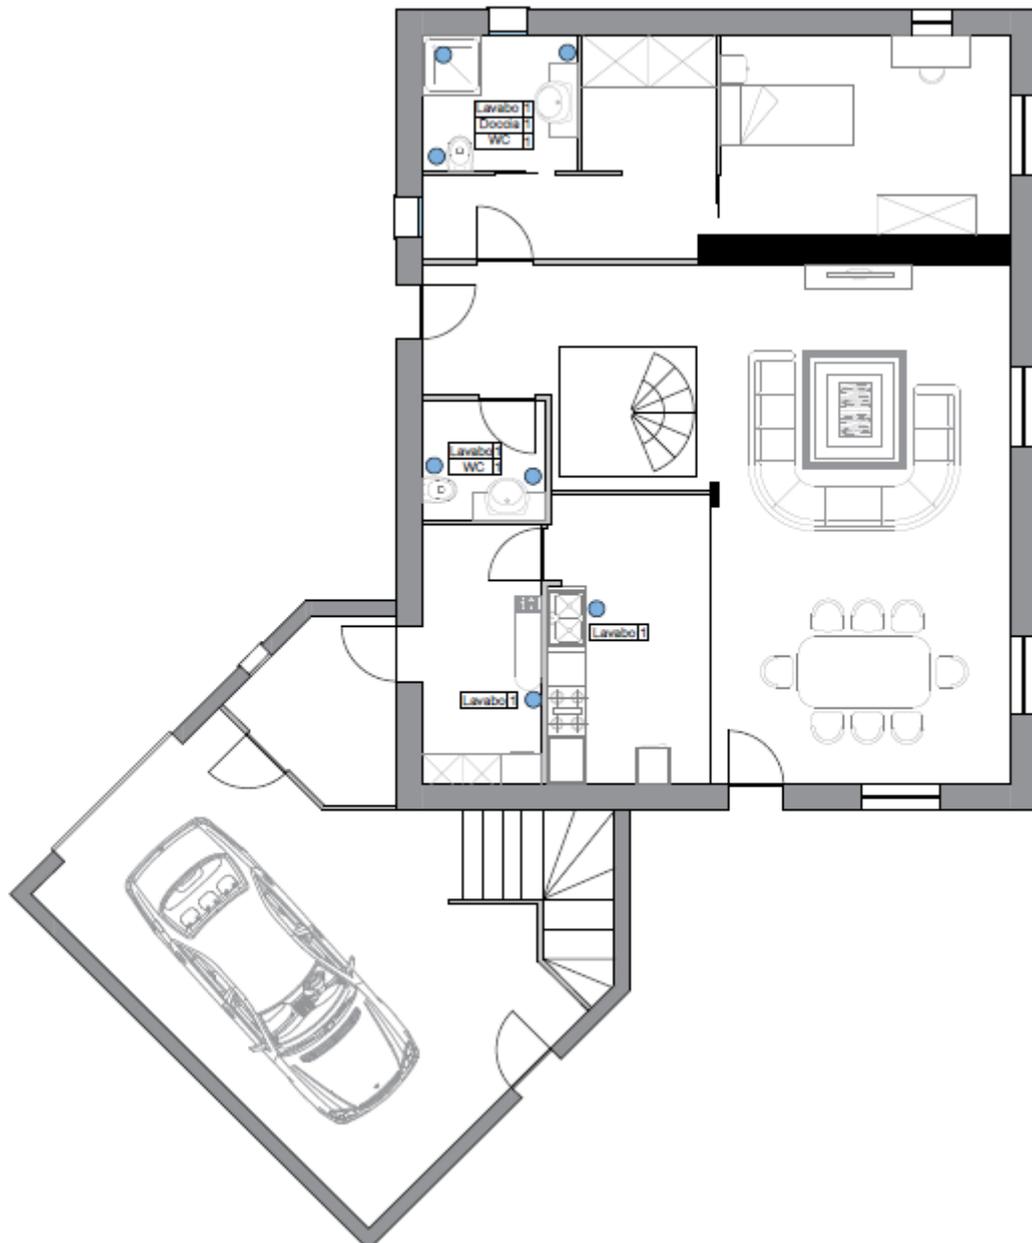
disposizione e tipologia degli apparecchi sanitari al piano terreno
